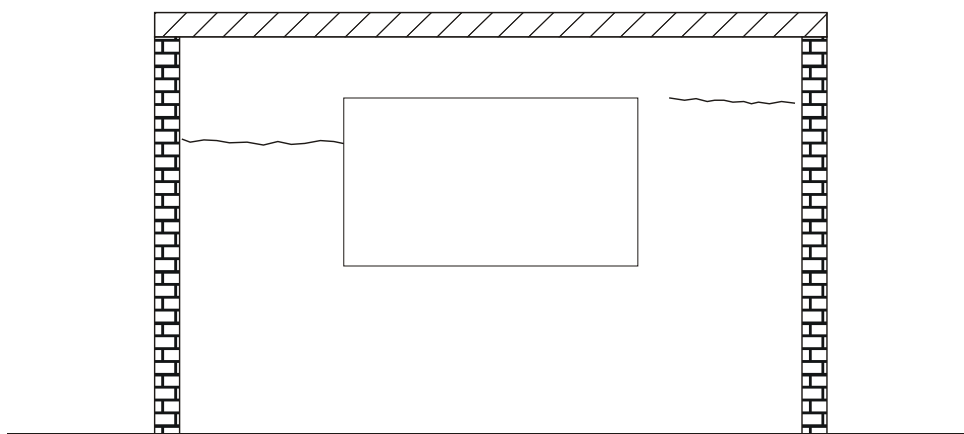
Fissuras provocadas pela retração por secagem de lajes de concreto armado, em geral nas paredes externas enfraquecidas por aberturas de janelas e portas
